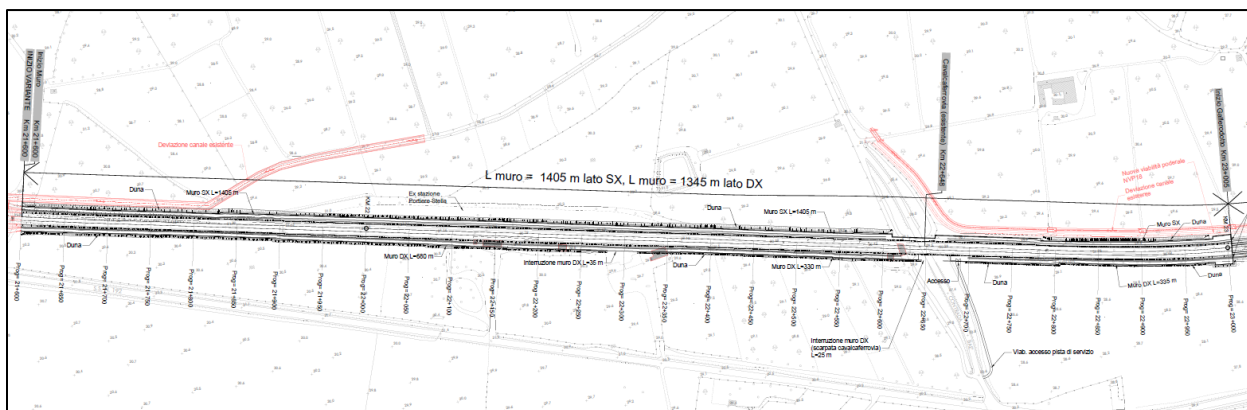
Planimetria del primo tratto interessato dalla variante con l'introduzione dei muri di protezione idraulica
